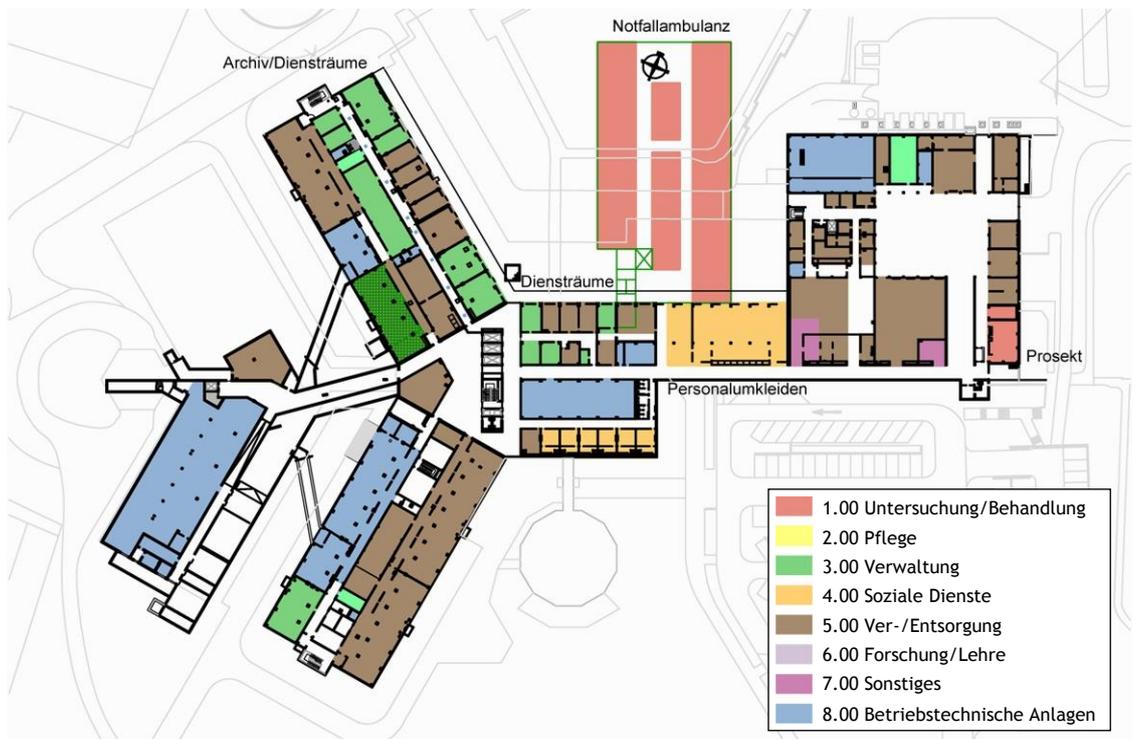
SOLL-Flächen nach DIN 13080 - 1.Untergeschoss
